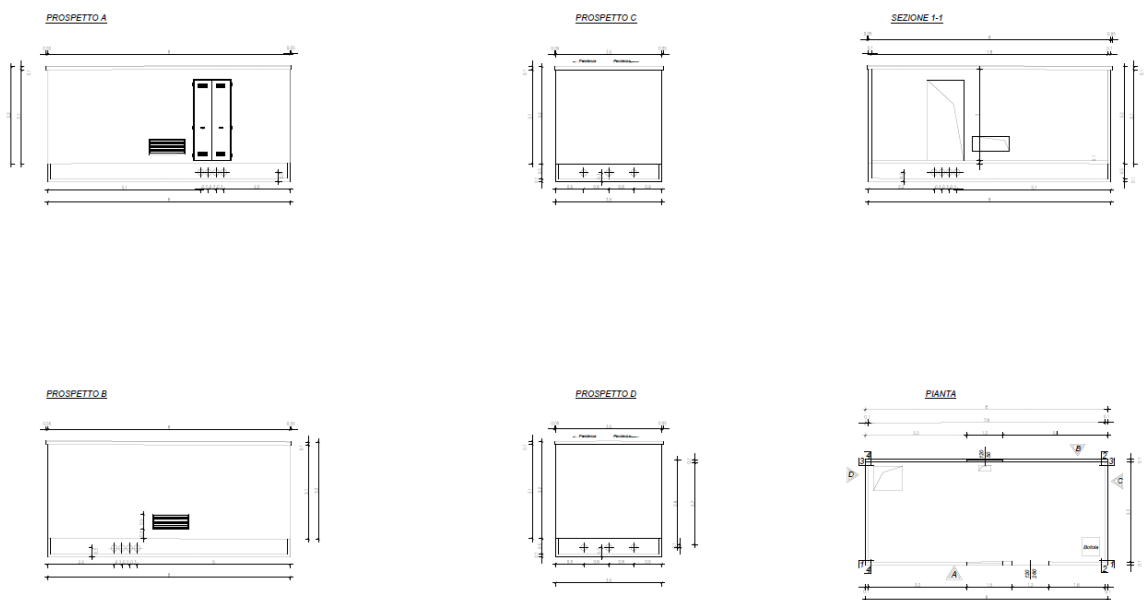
pianta, sezione prospetti delle stazioni di campo e sottocampo (power station).
